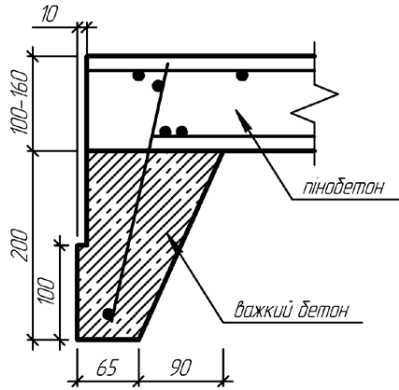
Деталь поперечного перерізу пінобетонної армованої плити
